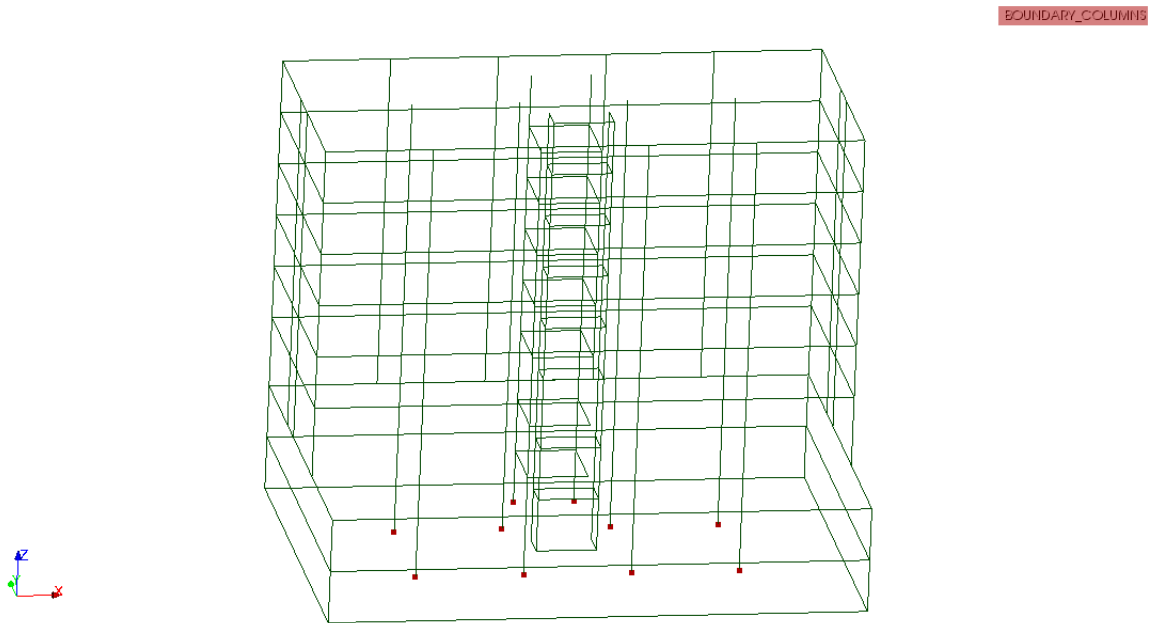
Encastrement des poteaux (groupe BOUNDARY\_COLUMNS)
